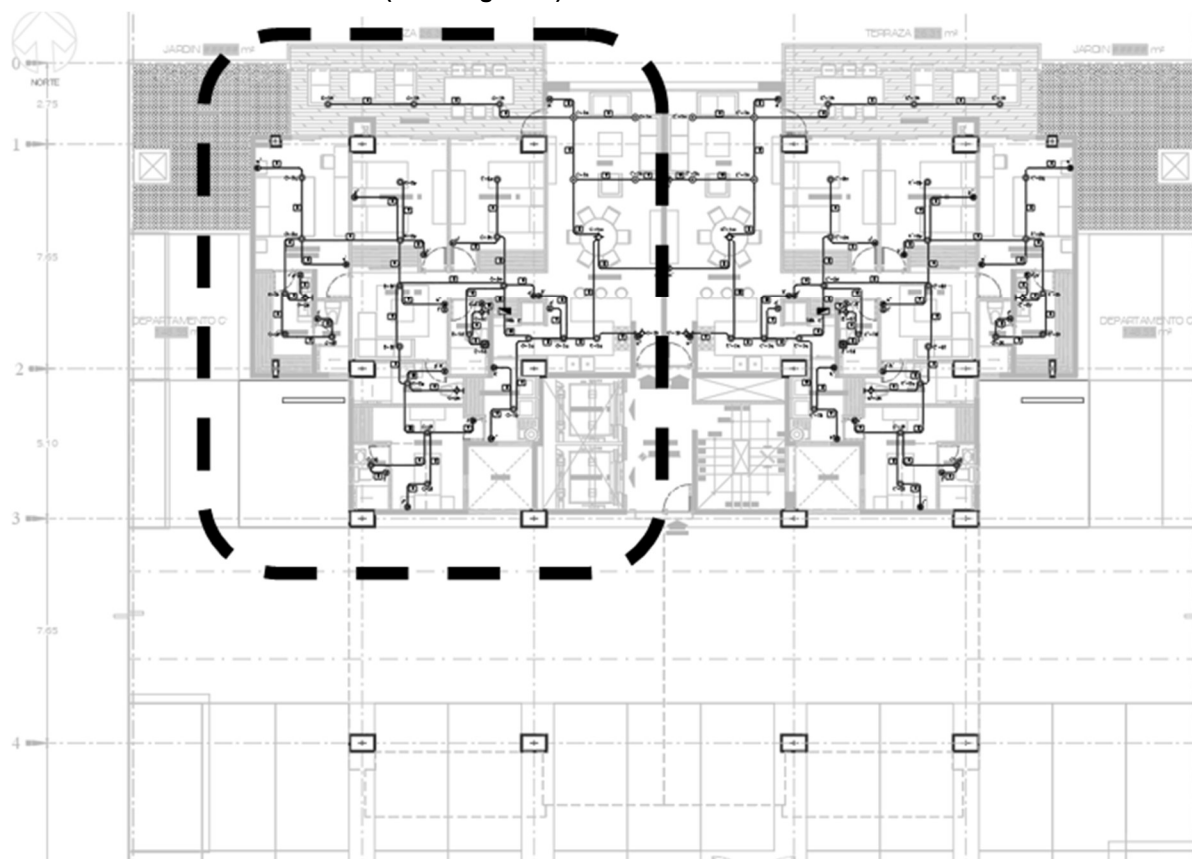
Instalación eléctrica Planta baja (Iluminación)
